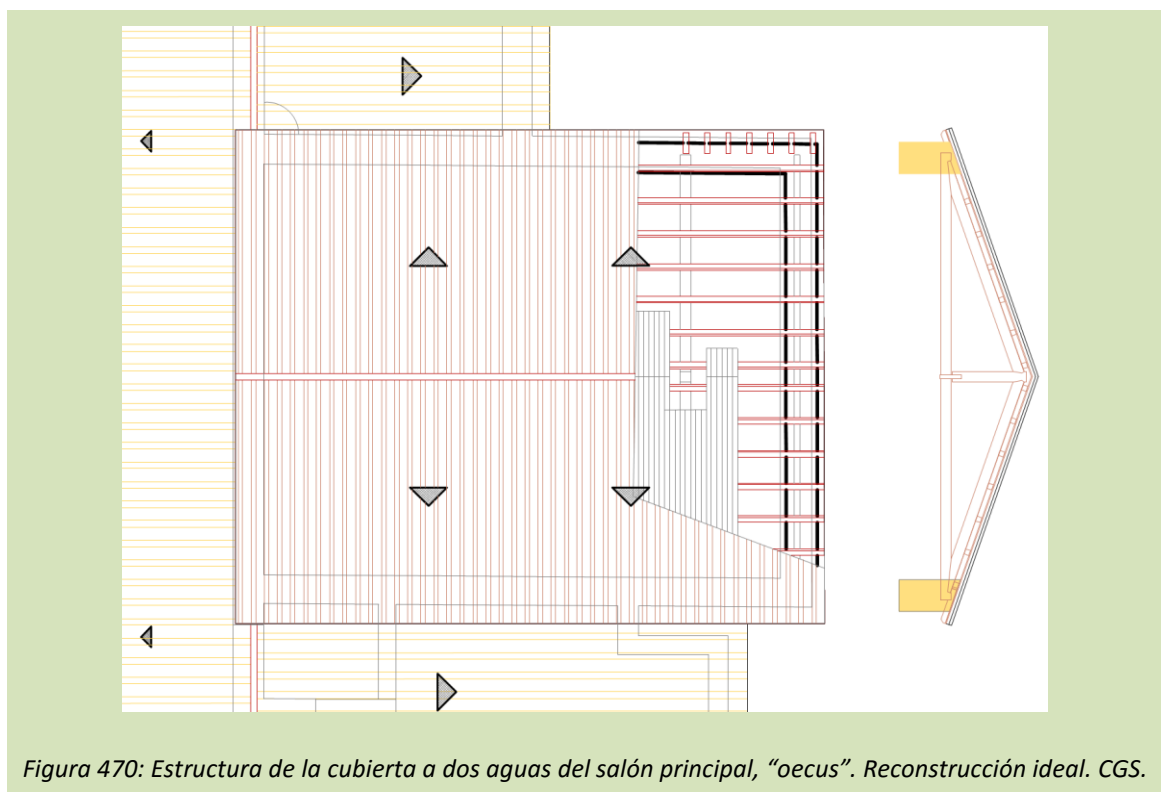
Estructura de la cubierta a dos aguas del salón principal, "oecus". Reconstrucción ideal. CGS.
